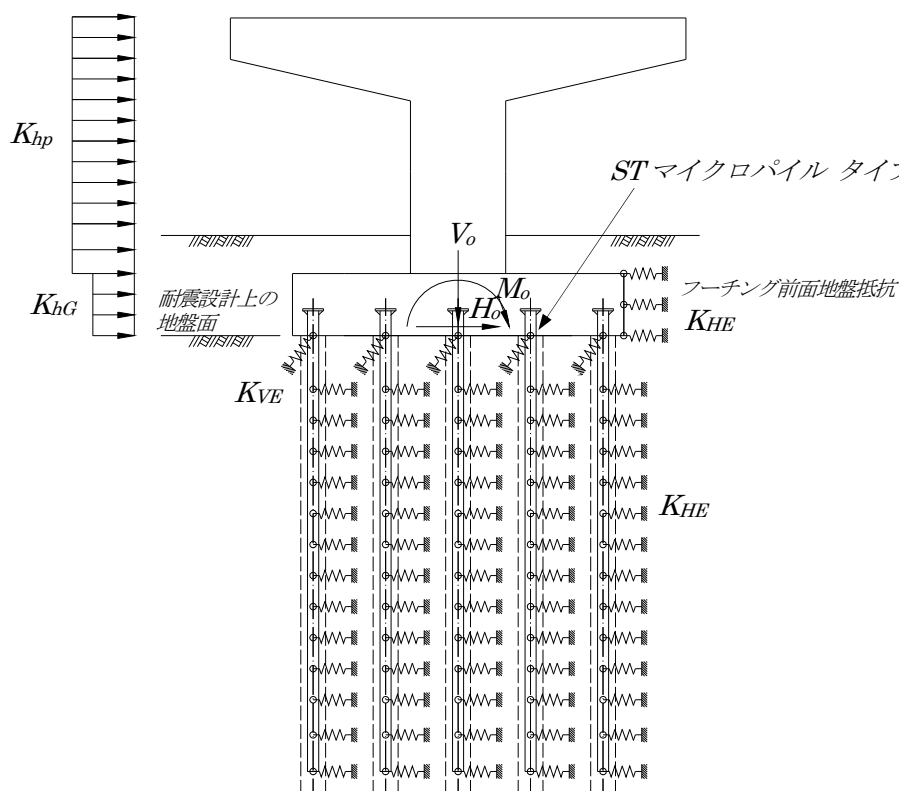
STMP タイプⅡから構成される杭基礎の解析モデル例
